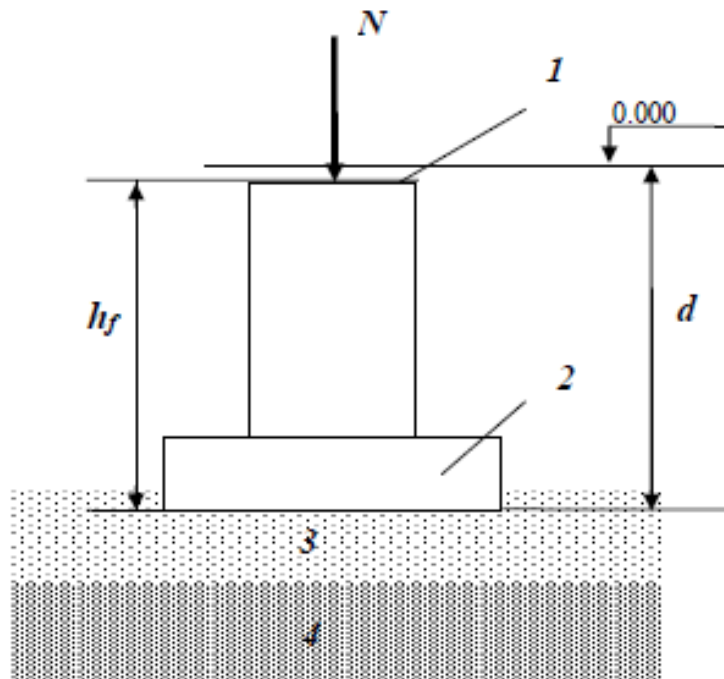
Основні елементи фундаменту: 1 – обріз фундаменту; 2 – підшошва фундаменту; 3 – несучий шар ґрунту (основа); 4 – підстиляючий шар ґрунту; N – вертикальне навантаження на фундамент; d – глибина закладання фундаменту; h_f – висота фундаменту
